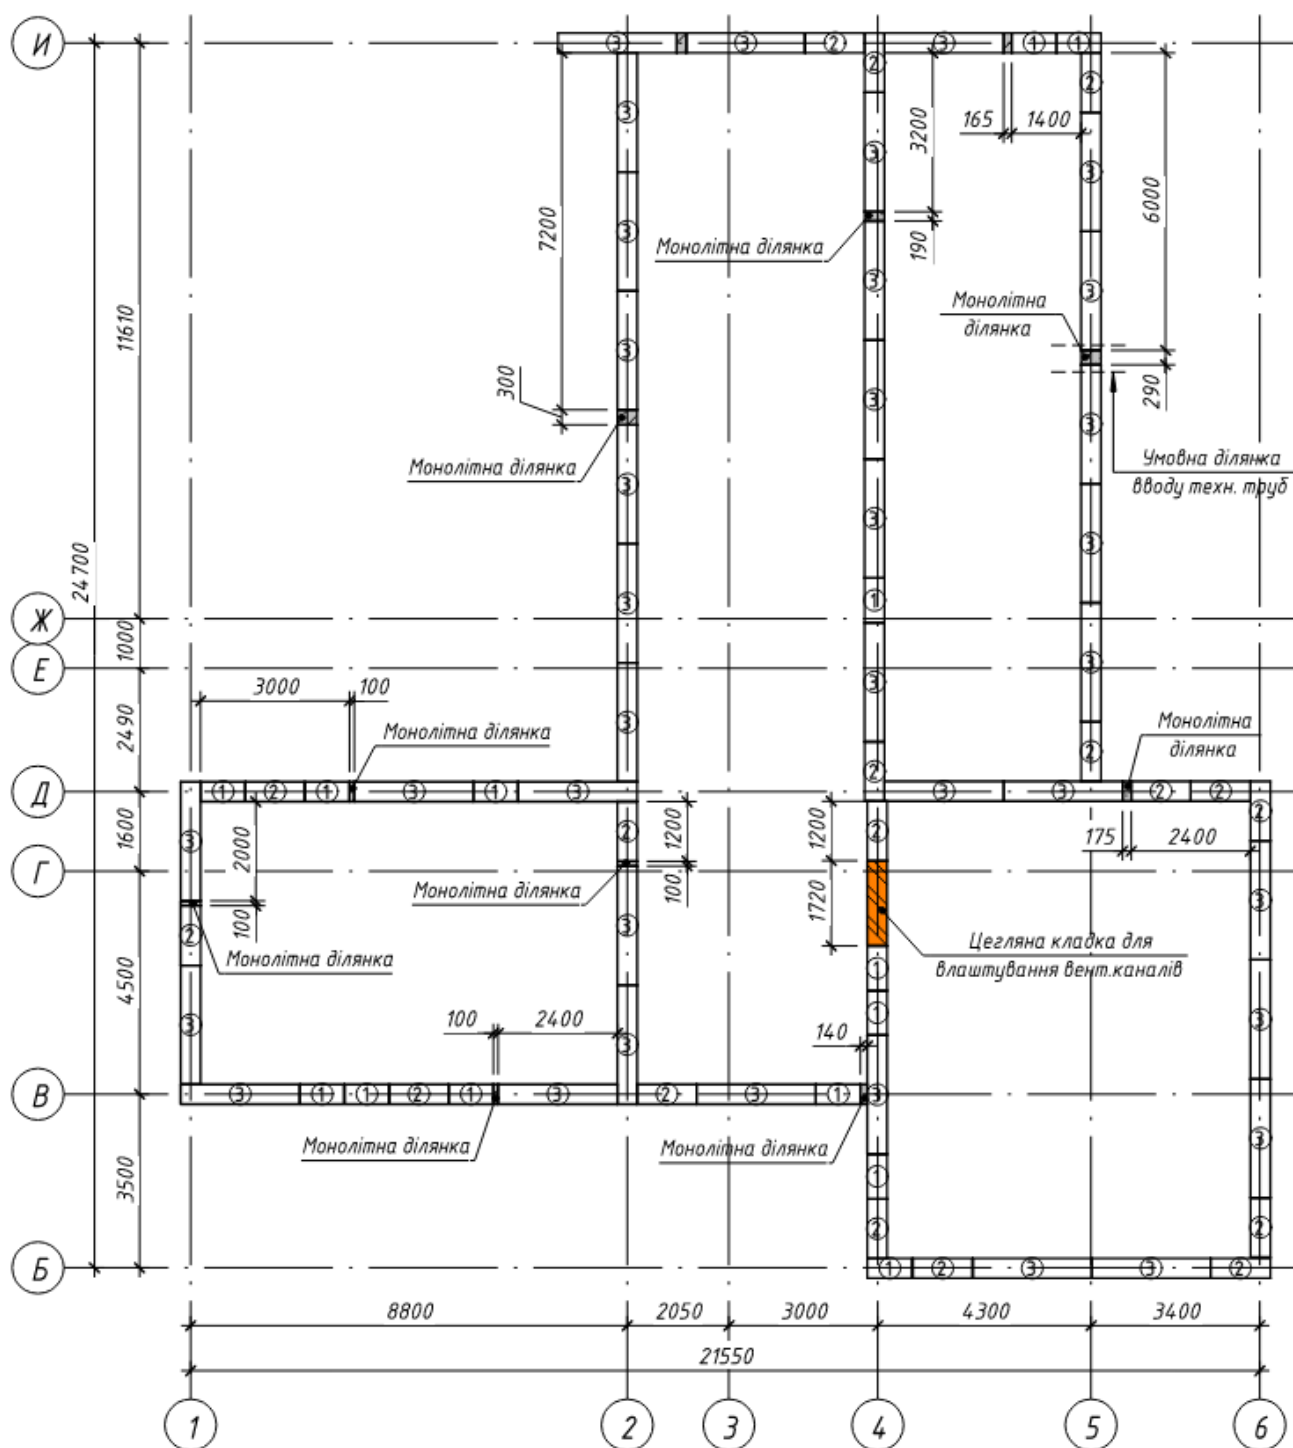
Схема розкладки блоків на відм. -1,550 (четвертий ряд)
